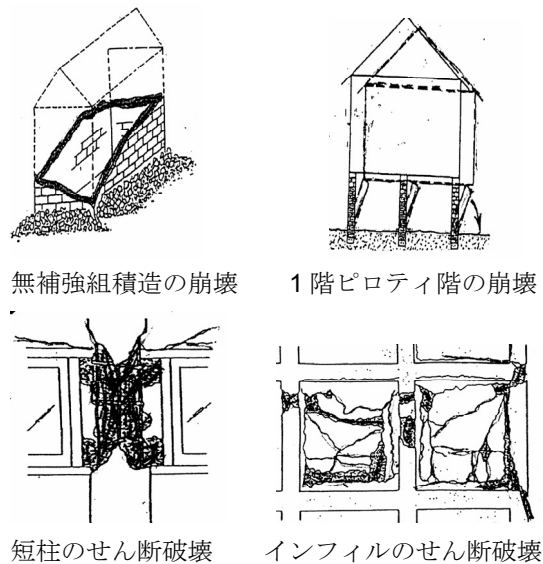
構造被害の特徴 (Structural Damaged Pattern)
